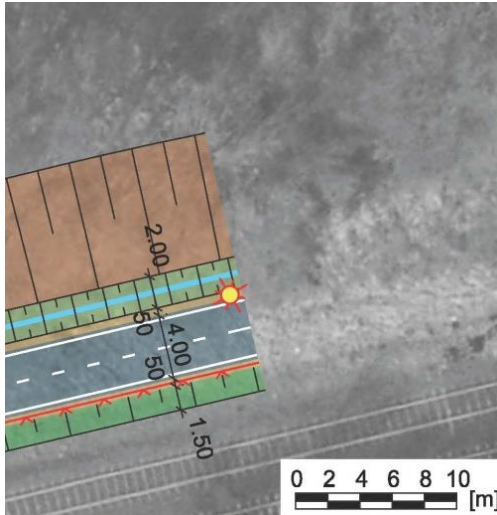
Bahnstrecke (Zweirichtungsradweg
